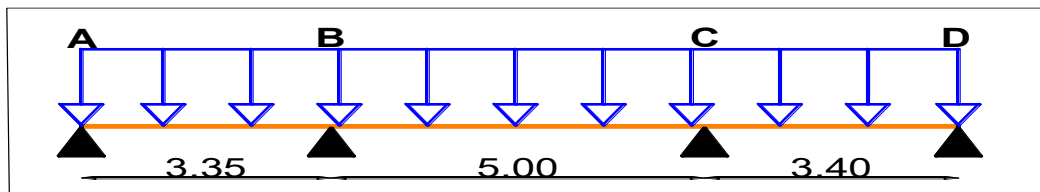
Schéma statique de la poutrelle type 03 (salle de conférences).
